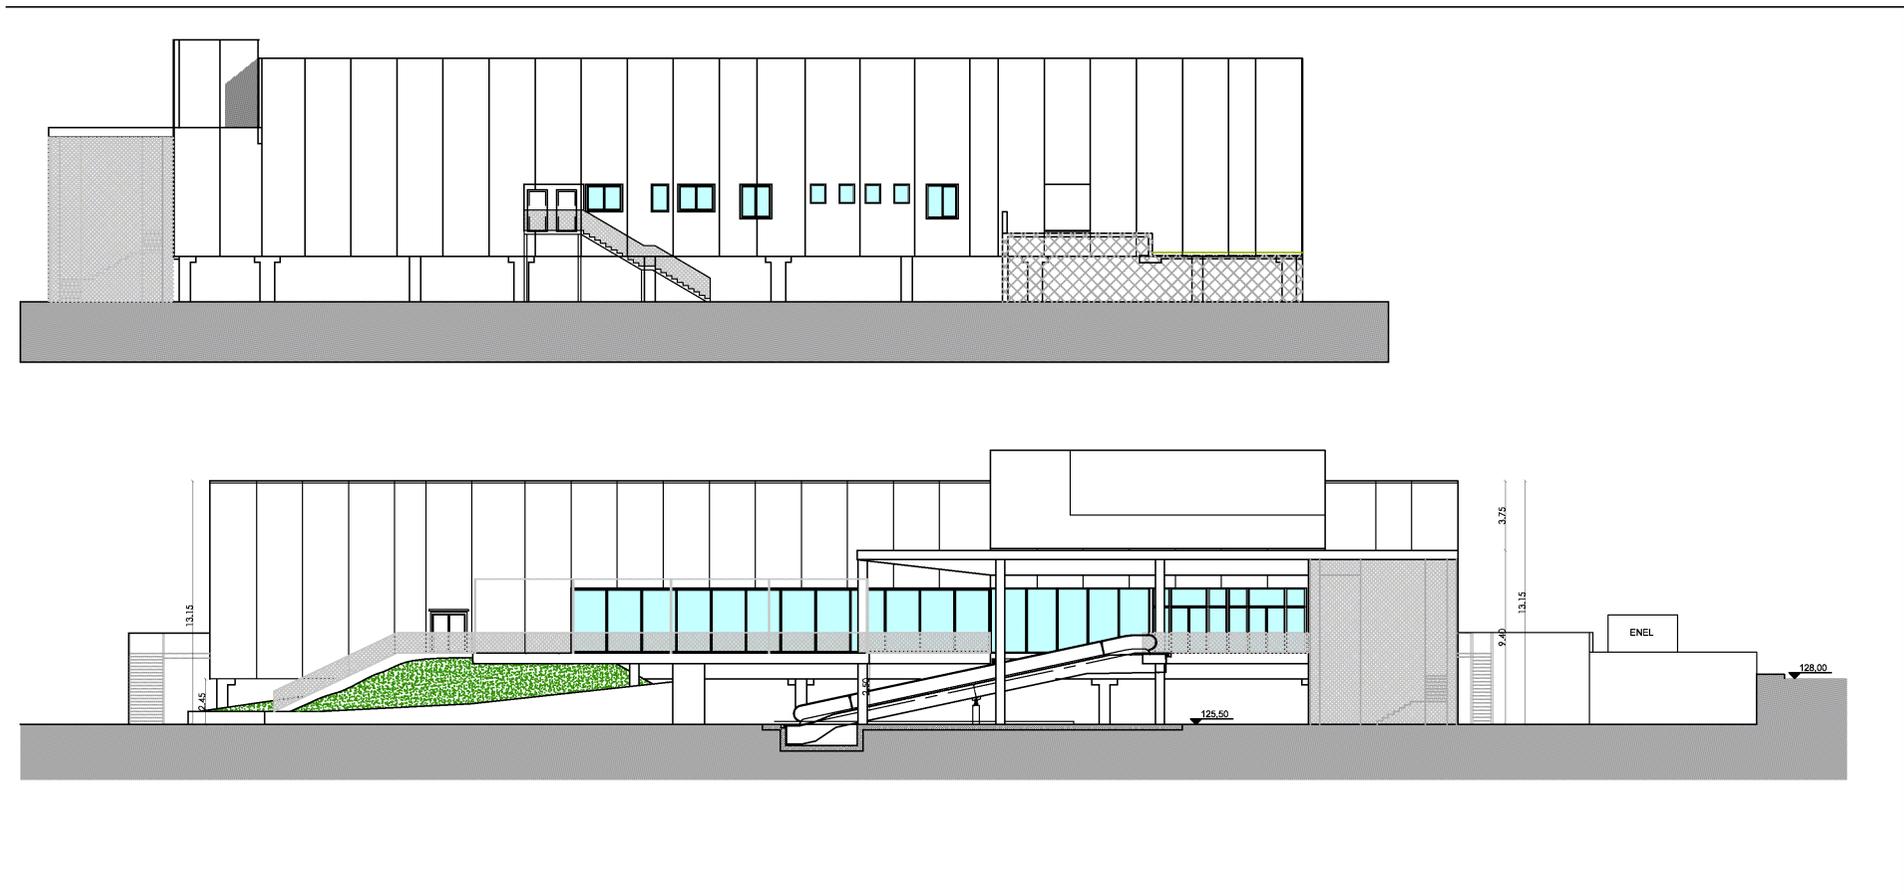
Prospetti Ovest e Nord (Variante in definizione - Tavola 2.4)
